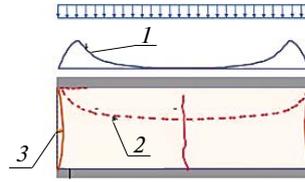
Эпюры напряжений и деформаций в кладке: 1 – эпюра касательных напряжений по шву между кладкой и плитой перекрытия τ ; 2 – эпюра горизонтальных растягивающих напряжений σ_x ; 3 – деформации усадки ε_s
